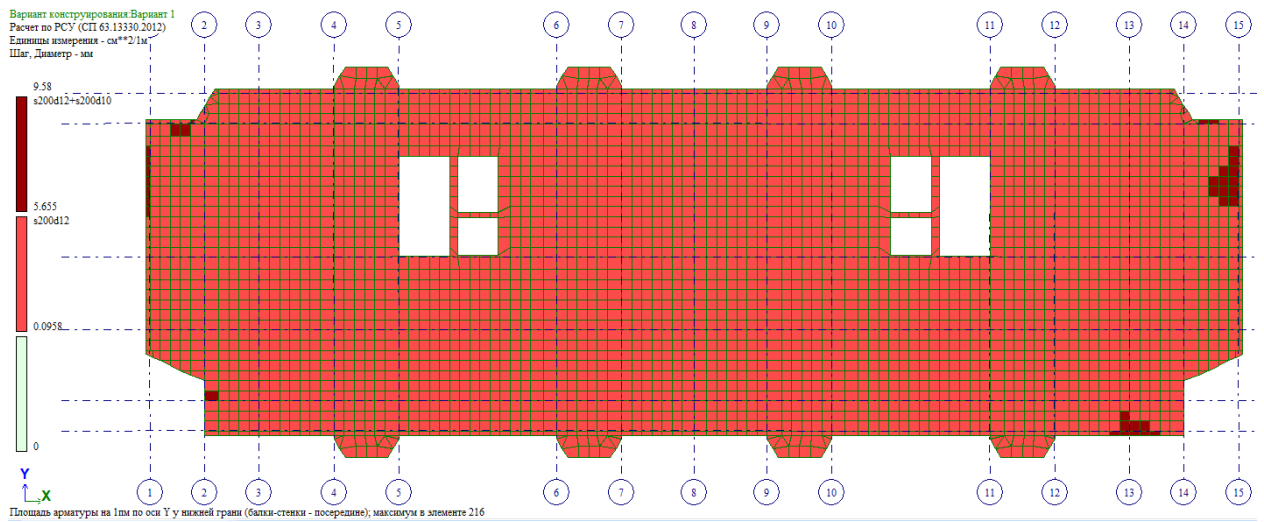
Подбор нижней продольной арматуры плиты по оси Y
